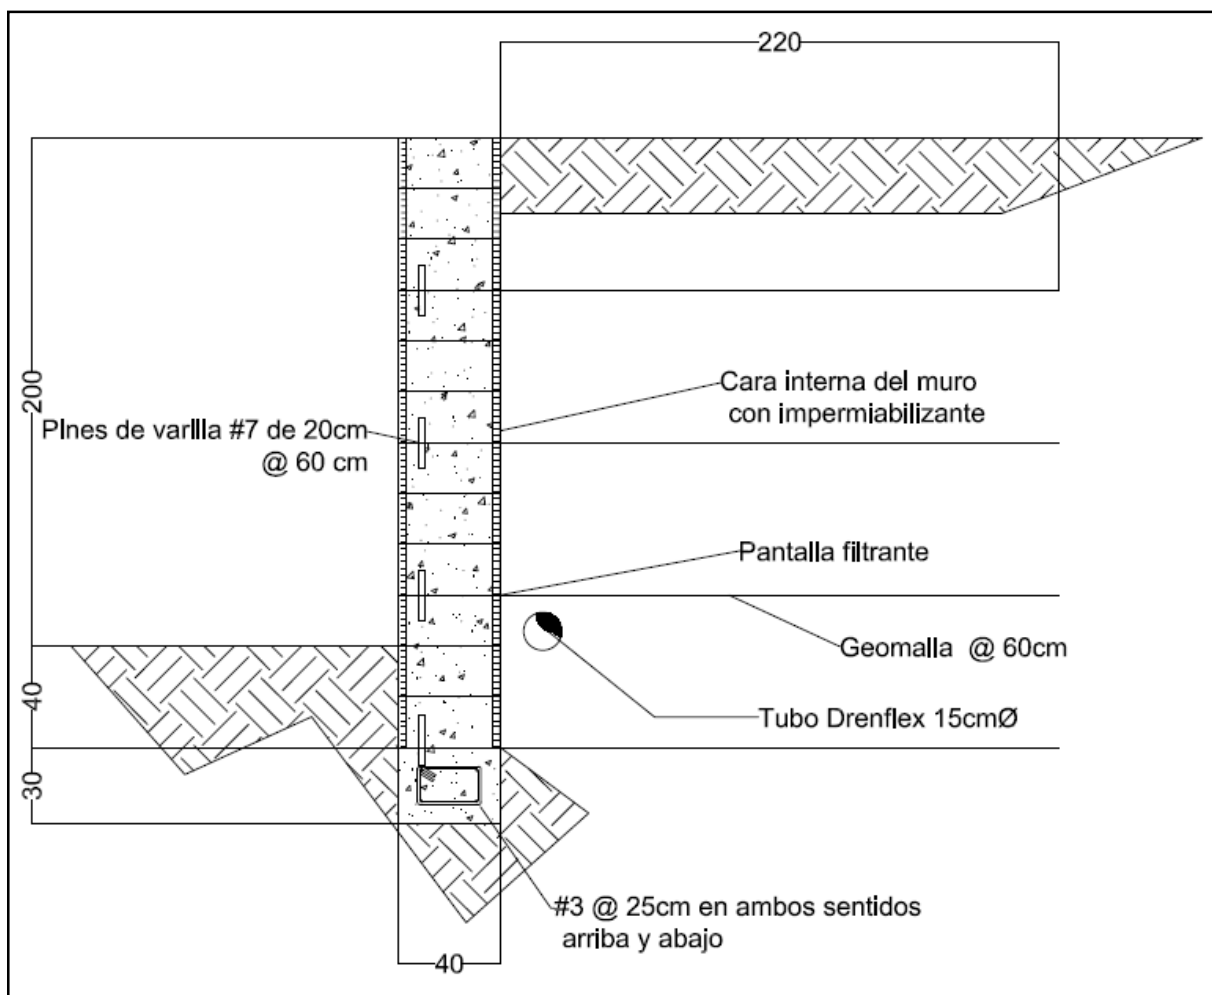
Esquema muro suelo reforzado 2 m cotas en cm
